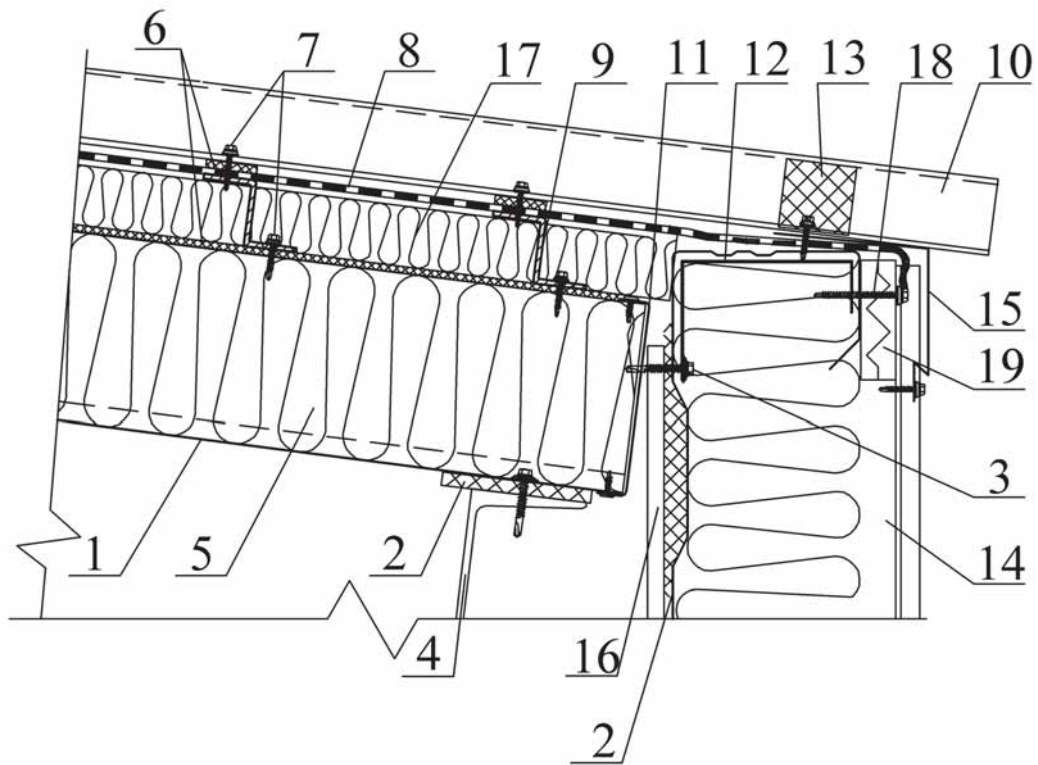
Узел сопряжения стены с кровлей Вариант «1»
